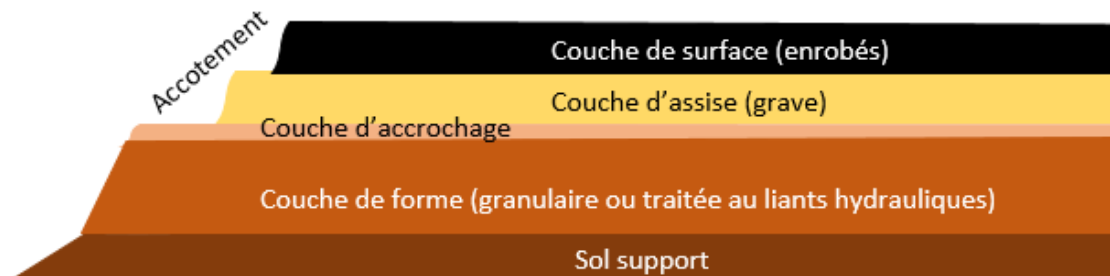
structure d'une chaussée traitée aux liants hydrauliques, source : personnelle
